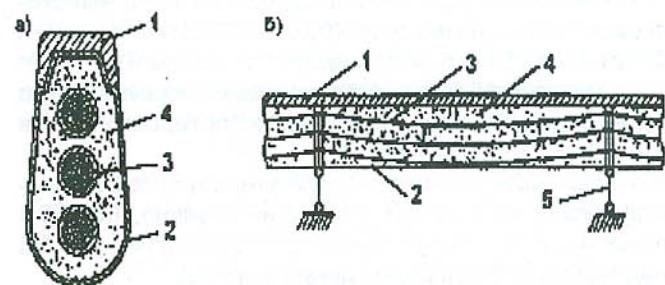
Конструкция рельса-струны: а) поперечный разрез; б) продольный разрез; 1 – головка; 2 – корпус; 3 – струна; 4 – заполнитель; 5 – поддерживающая опора
